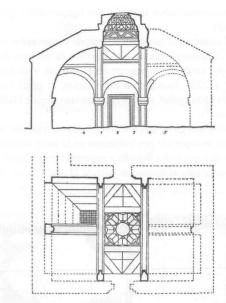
Planta y sección del *gavit* del Monasterio de Arates (Cuneo 1988)
